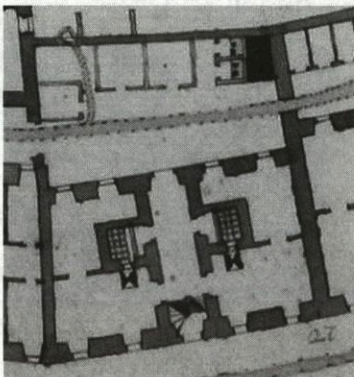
Obermünsterstraße 6, vor 1766 (Münchner Plan).
